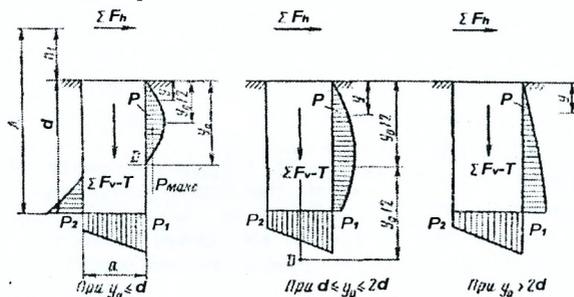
Схема расчета заделки фундамента в грунте
